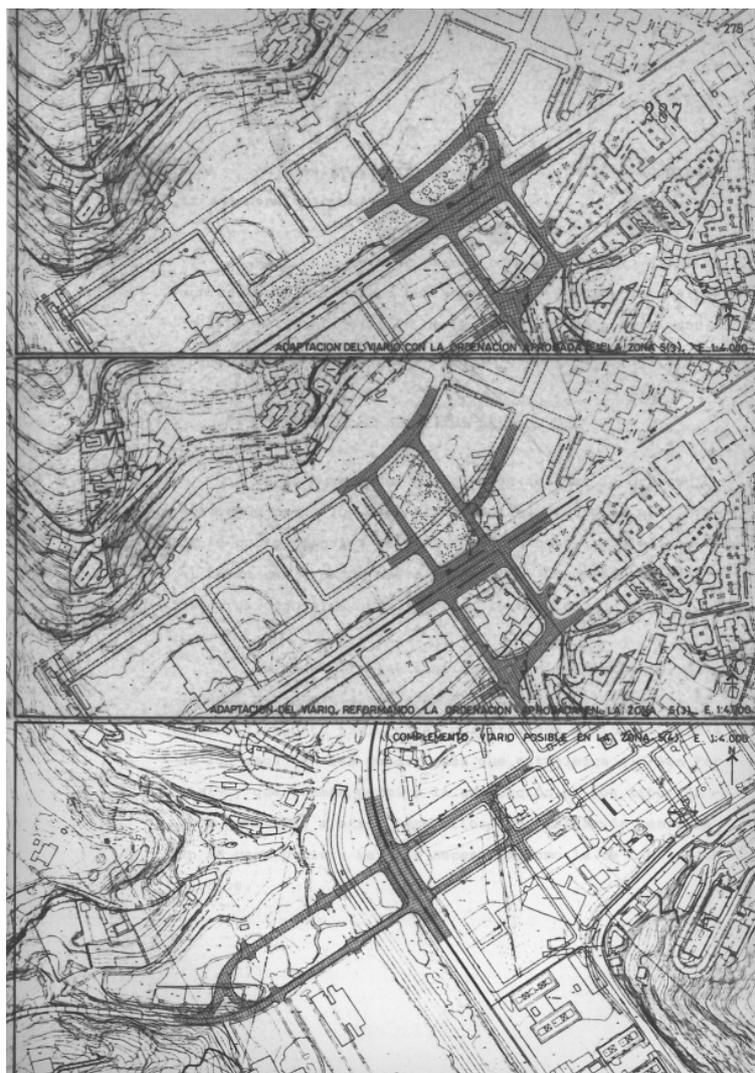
Plano de la Modificación de trazados en las intersecciones y accesos - M.E.P.G.
